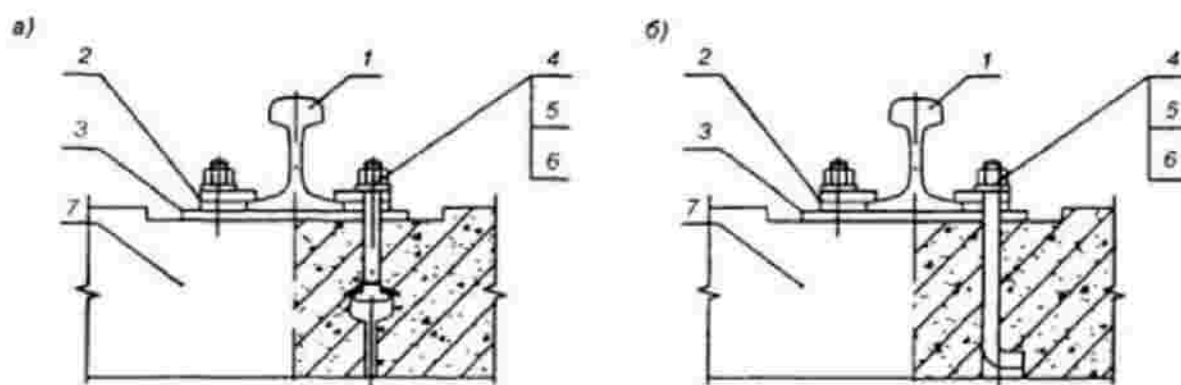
Промежуточное крепление рельса с железобетонной балкой
